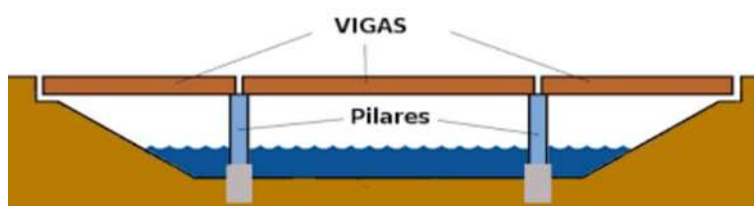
Puente tipo viga o viguetas. (*blogspot.mx*, 2013)
